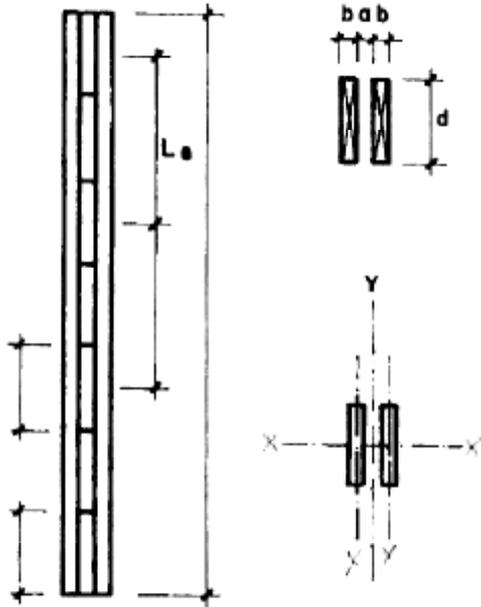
Columna compuesta por dos piezas separadas por bloques.
